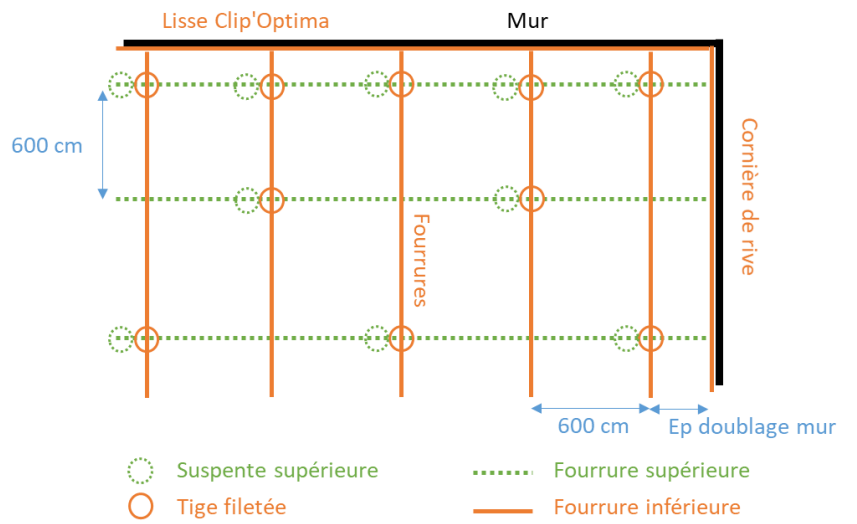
Pose des ossatures métalliques et du parement : cas d'un plafond horizontal avec suspente Stit® F530
